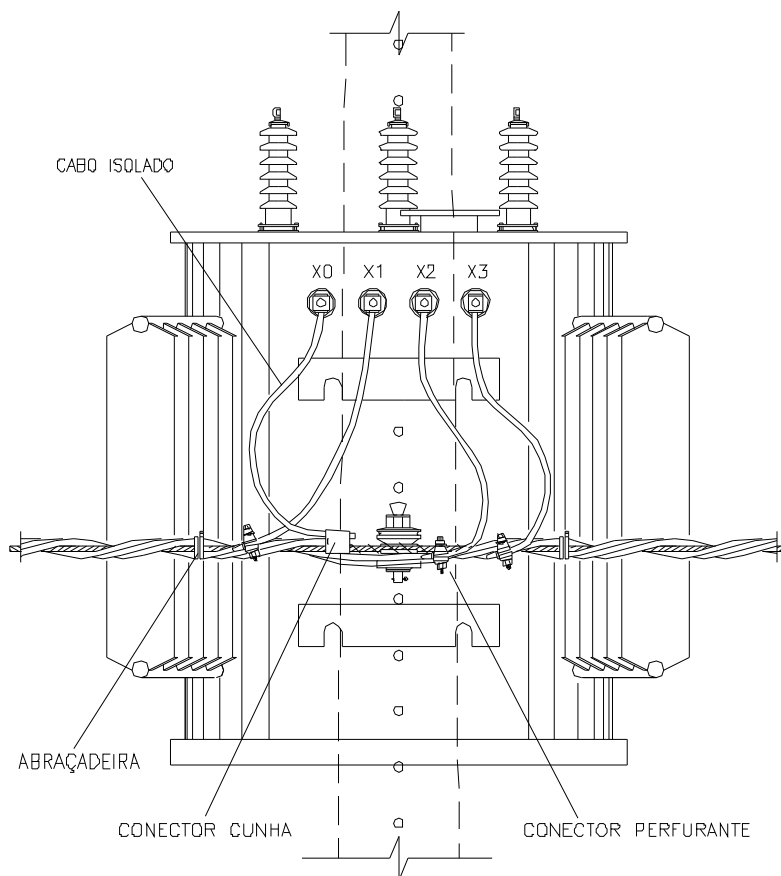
Amarrações e ligações – Secundário – ligação de baixa tensão do transformador
